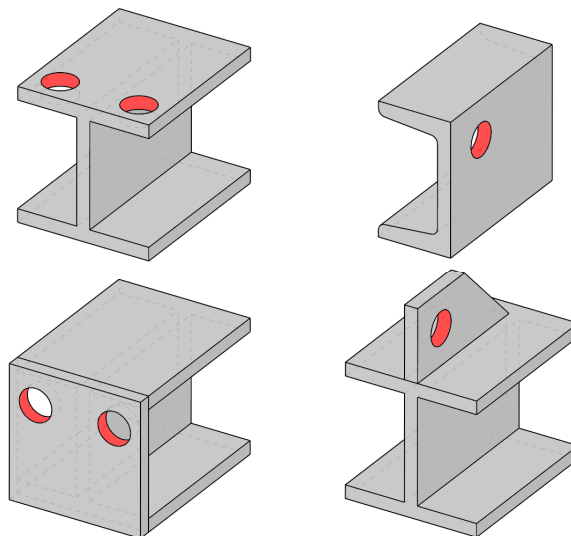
Pravilno in nepravilno izdelovanje odprtij
